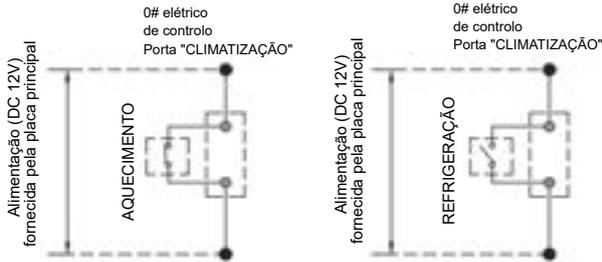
Cablagem da porta elétrica fraca "HEAT/COOL"
